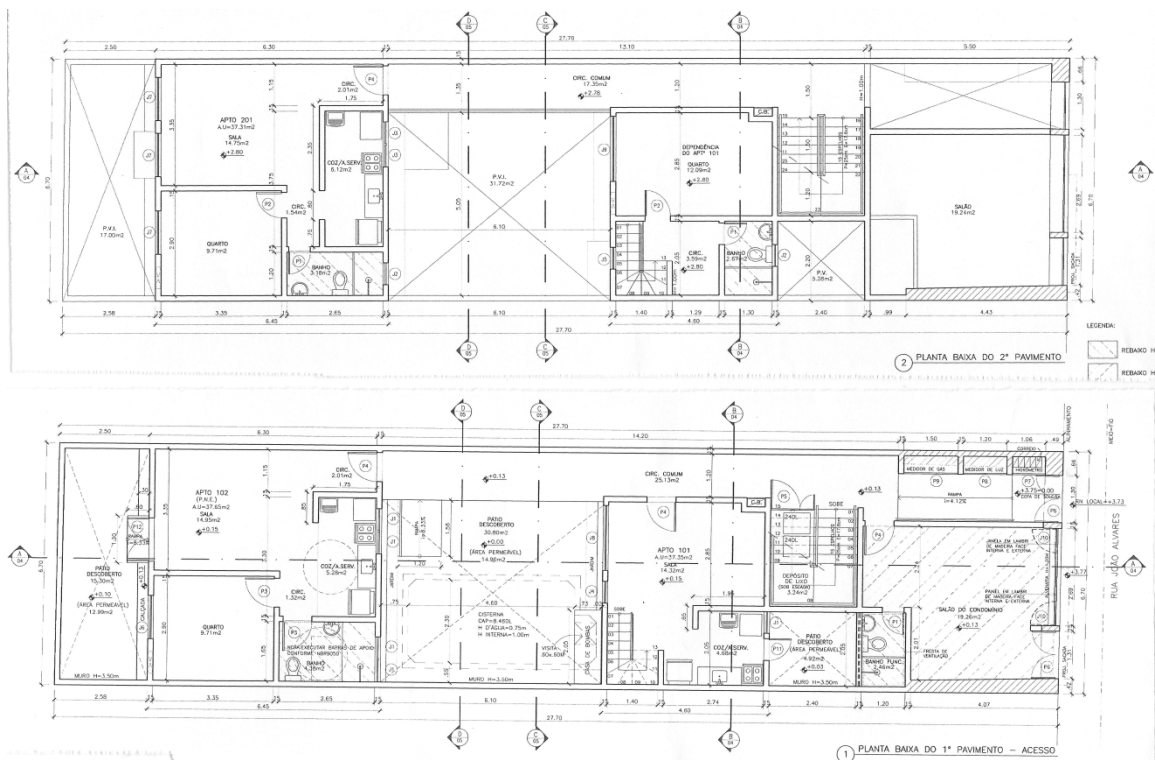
Planta baixa do 2º e 1º pavimento do empreendimento João Álvares 18.
